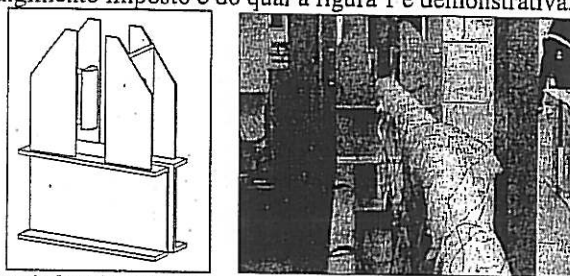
Apoios de forquilha nas vigas em estudo e carregamento em ensaio de perfis IPE100.
